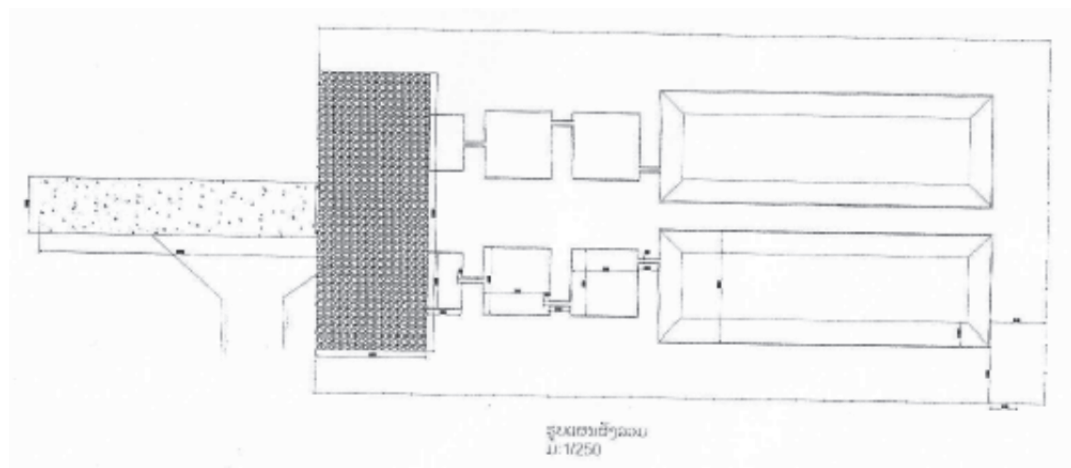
し尿浄化槽汚泥処理施設の竣工平面図
